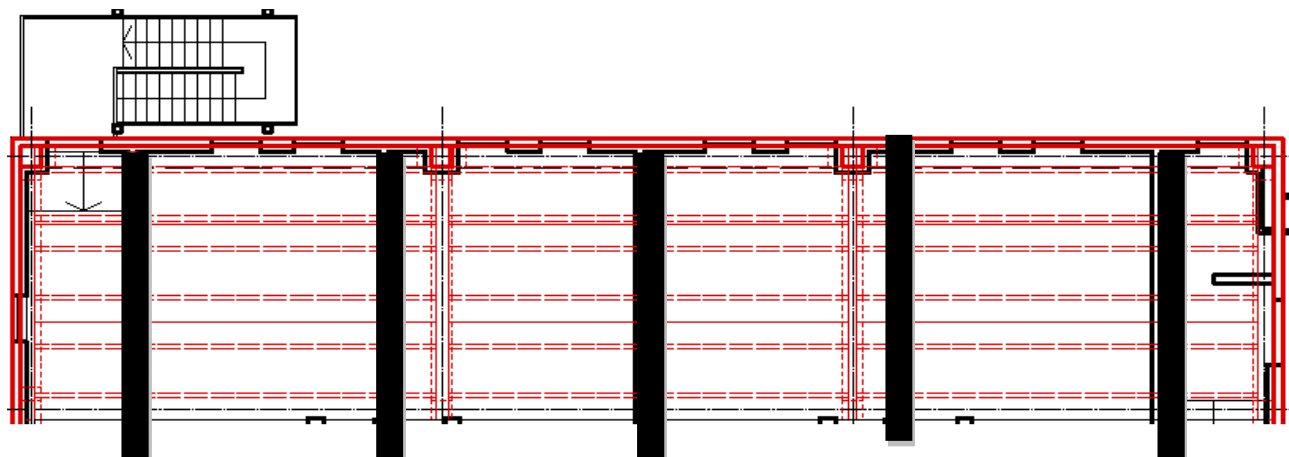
Planimetria parziale P2 zona Expo (in rosso tratteggiato sono individuate le anime dei tegoli doppio T di P2 originario, in nero continuo la posizione degli elementi divisorii inseriti nel corso del 2013)
